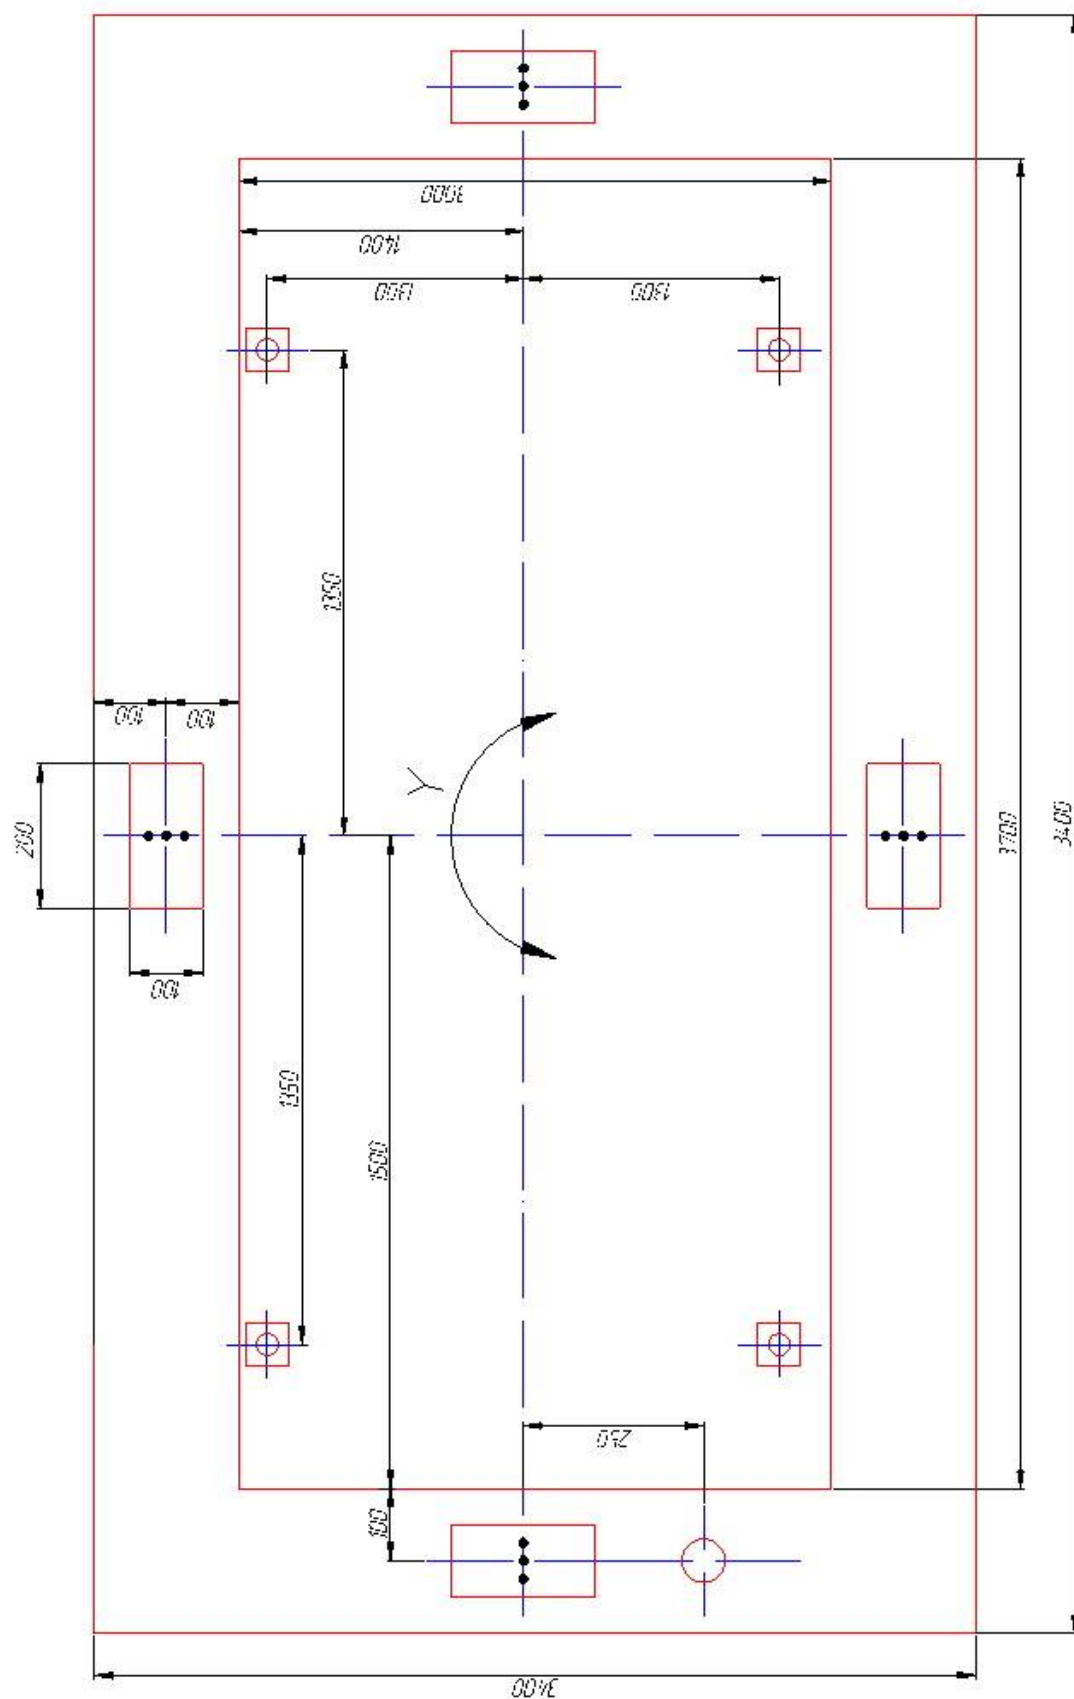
Схема геодезичного обґрунтування монтажу
